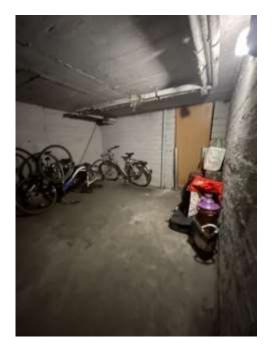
Fahrradkeller Kaiser-Friedrich-Straße
